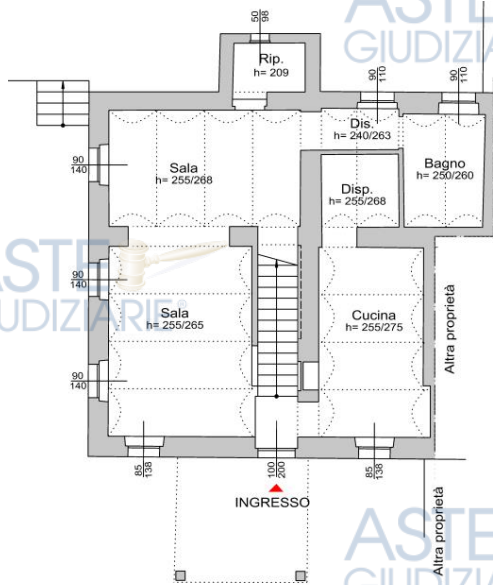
Rilievo piano terra eseguito dalla CTU- estratto di Allegato A) Elaborati grafici
